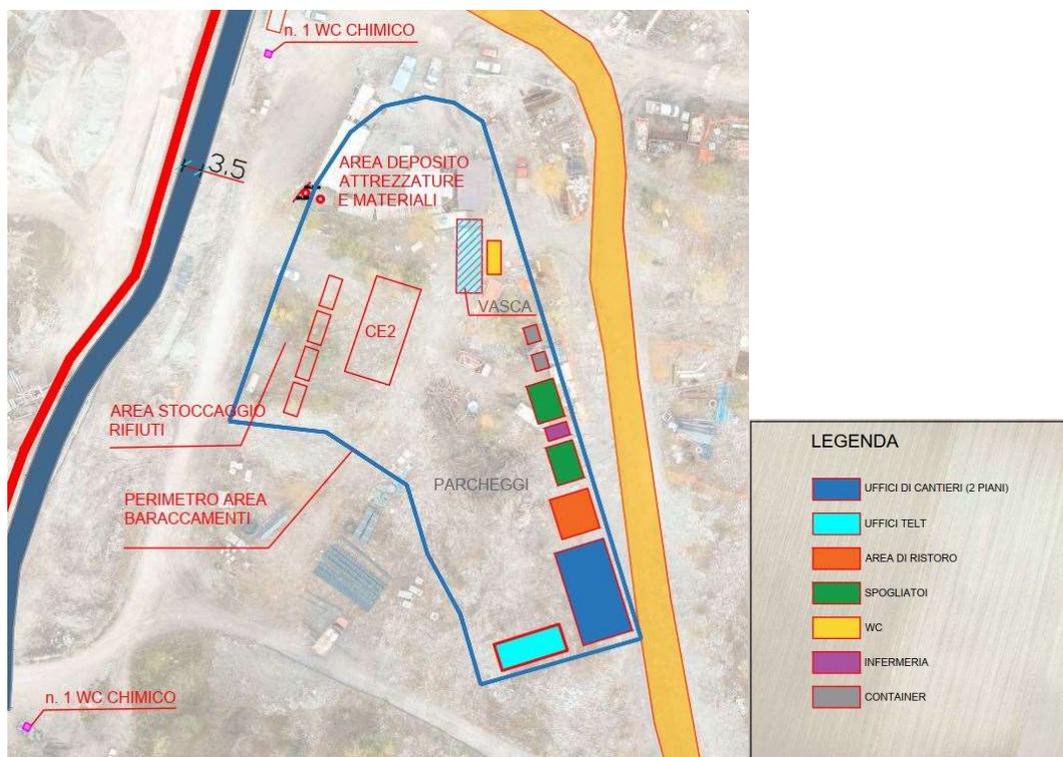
Area uffici cantiere e baraccamenti indicata con freccia rossa
